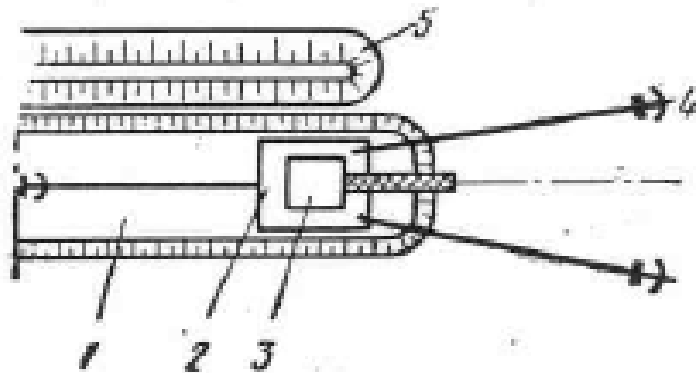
Схема разработки траншеи экскаватором на понтоне:
